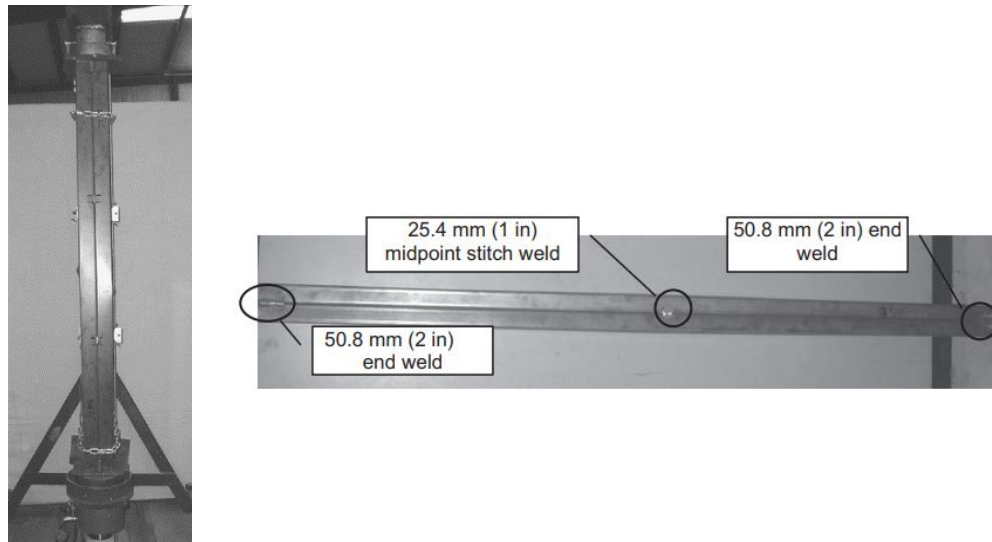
Perfiles soldados en prueba a compresión y longitudes de soldadura. [8]
